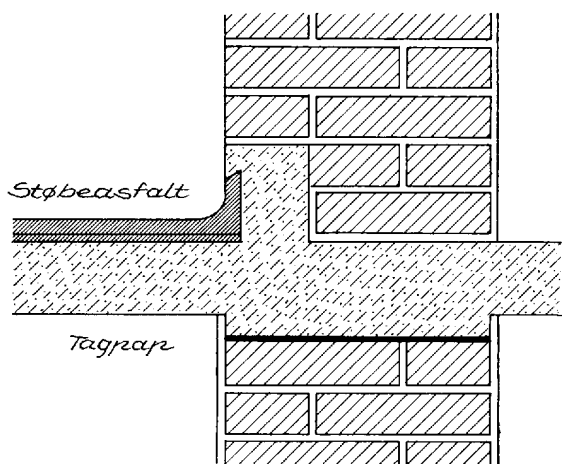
Inddækning med støbt rille til asfalthulkehl mellem mur og betontag med asfalt.
